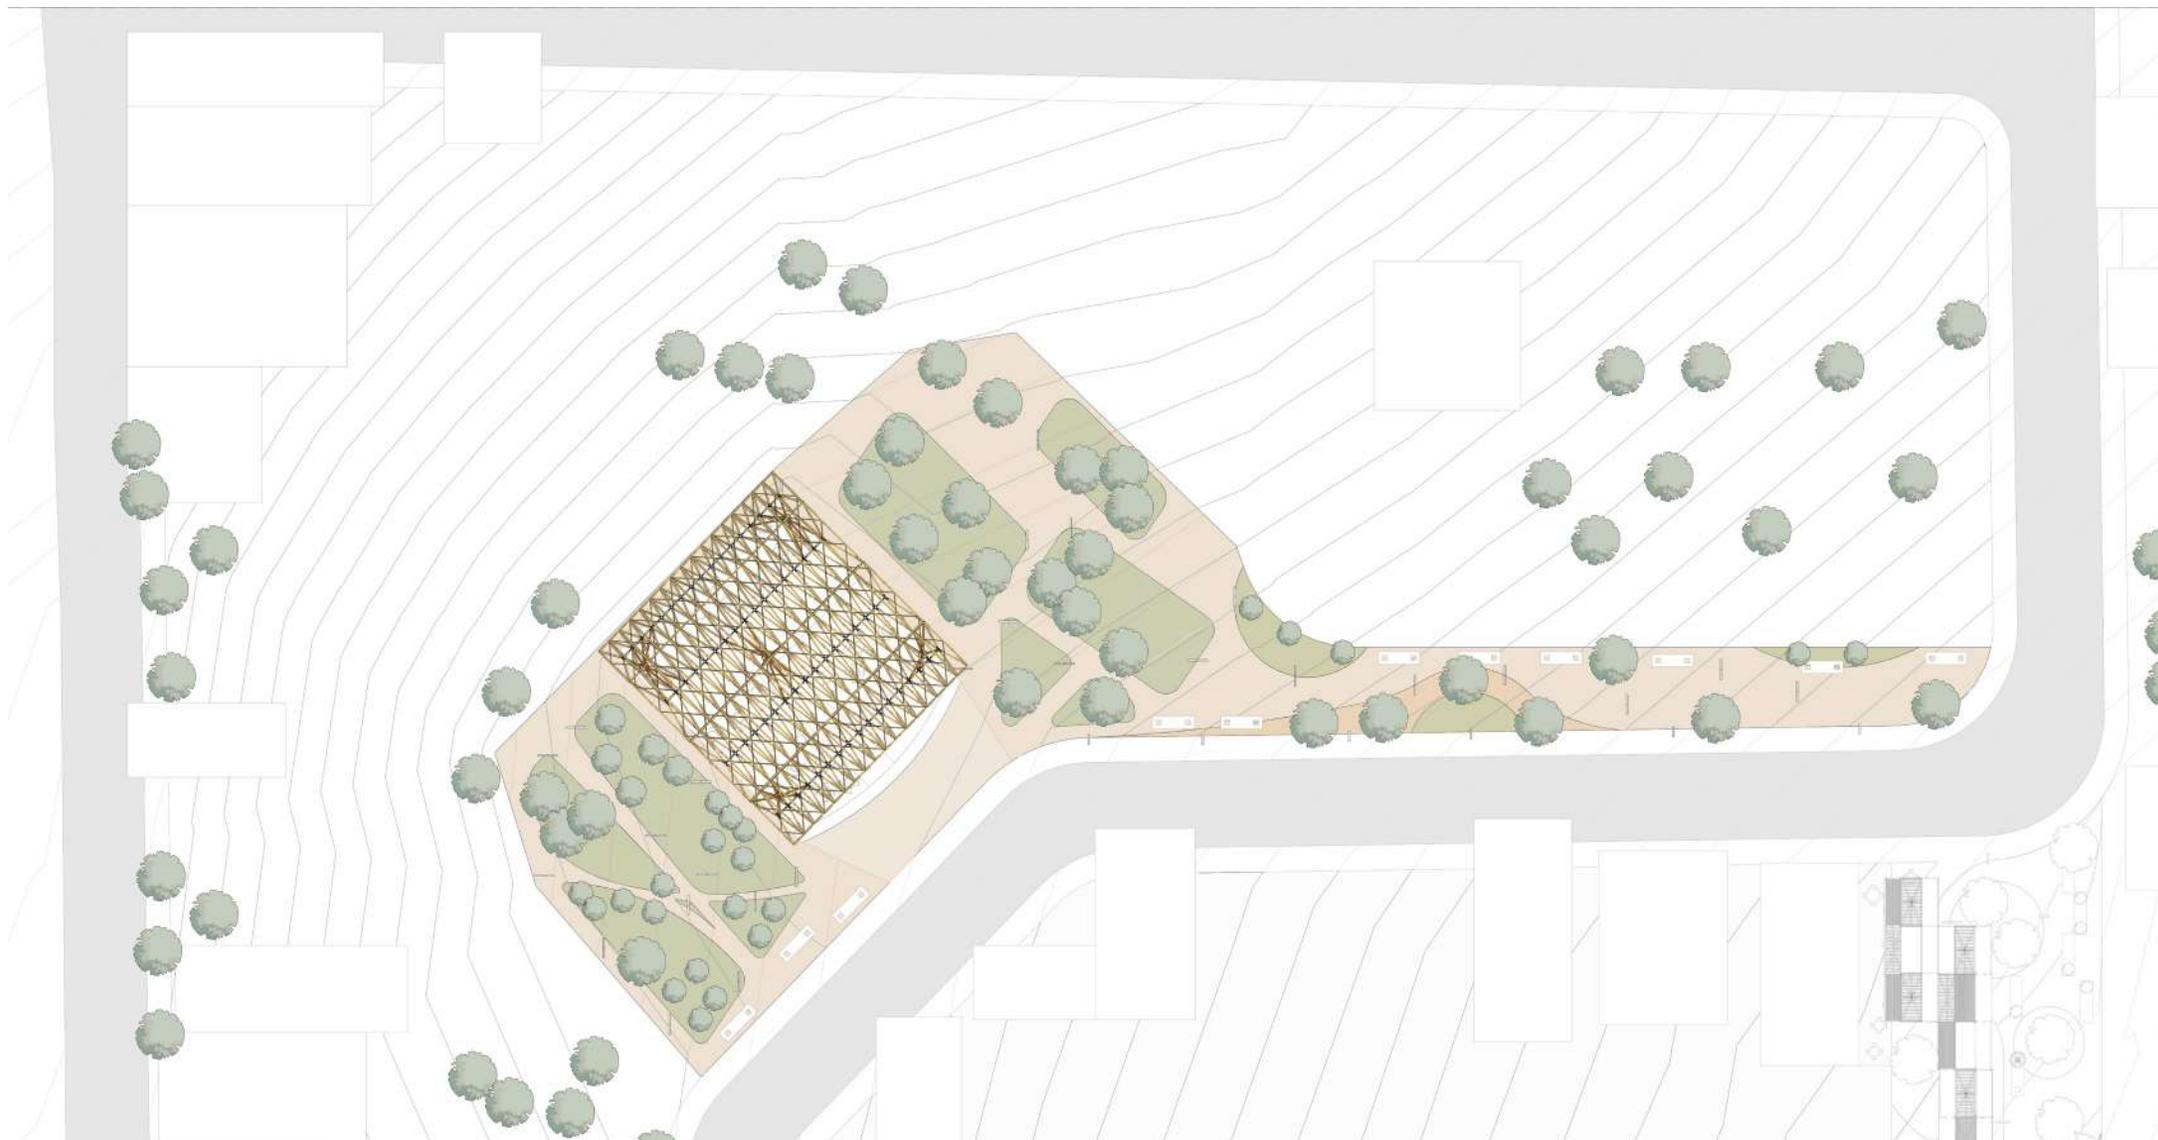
Planta Estrutura Fábrica de Hortaliças
